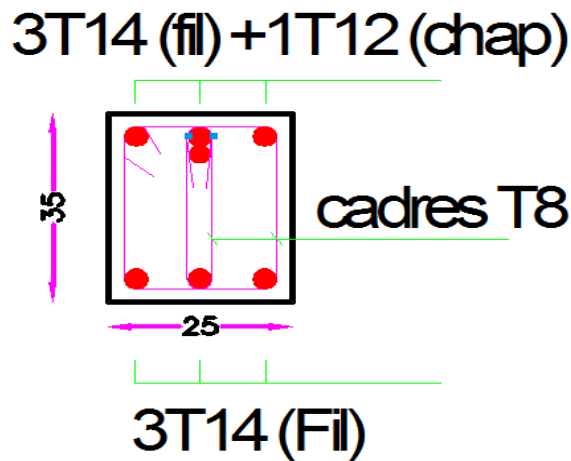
Ferraillage de poutre de ferme (charpente)
